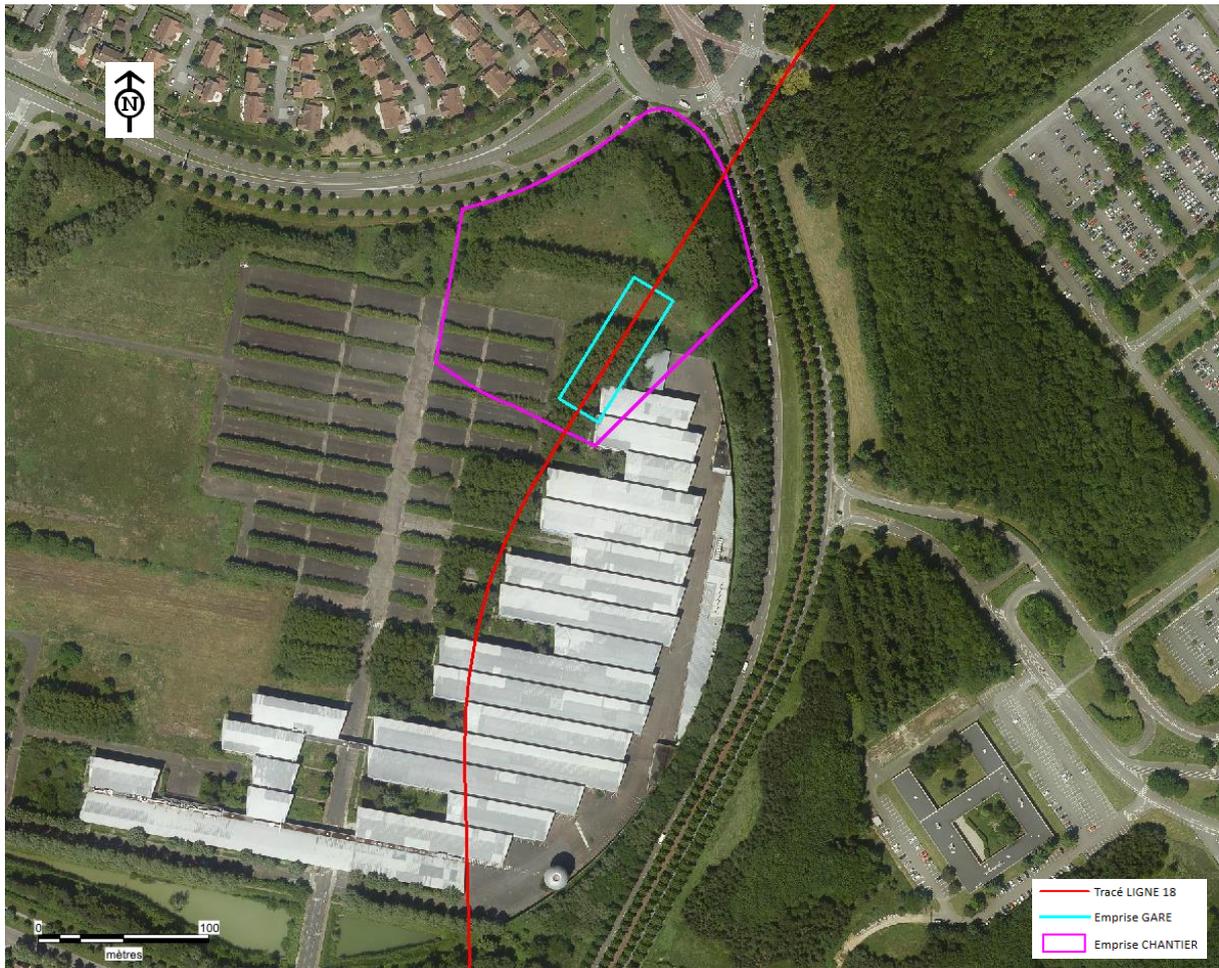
Plan d'implantation de la gare de Saint Quentin Est (53SQE) (source SGP)
